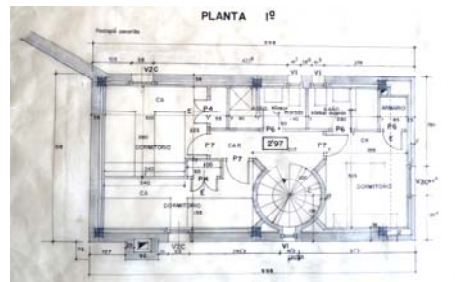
Planta primera casa El Chuego. Archivo de Heliodoro Dols Morell
